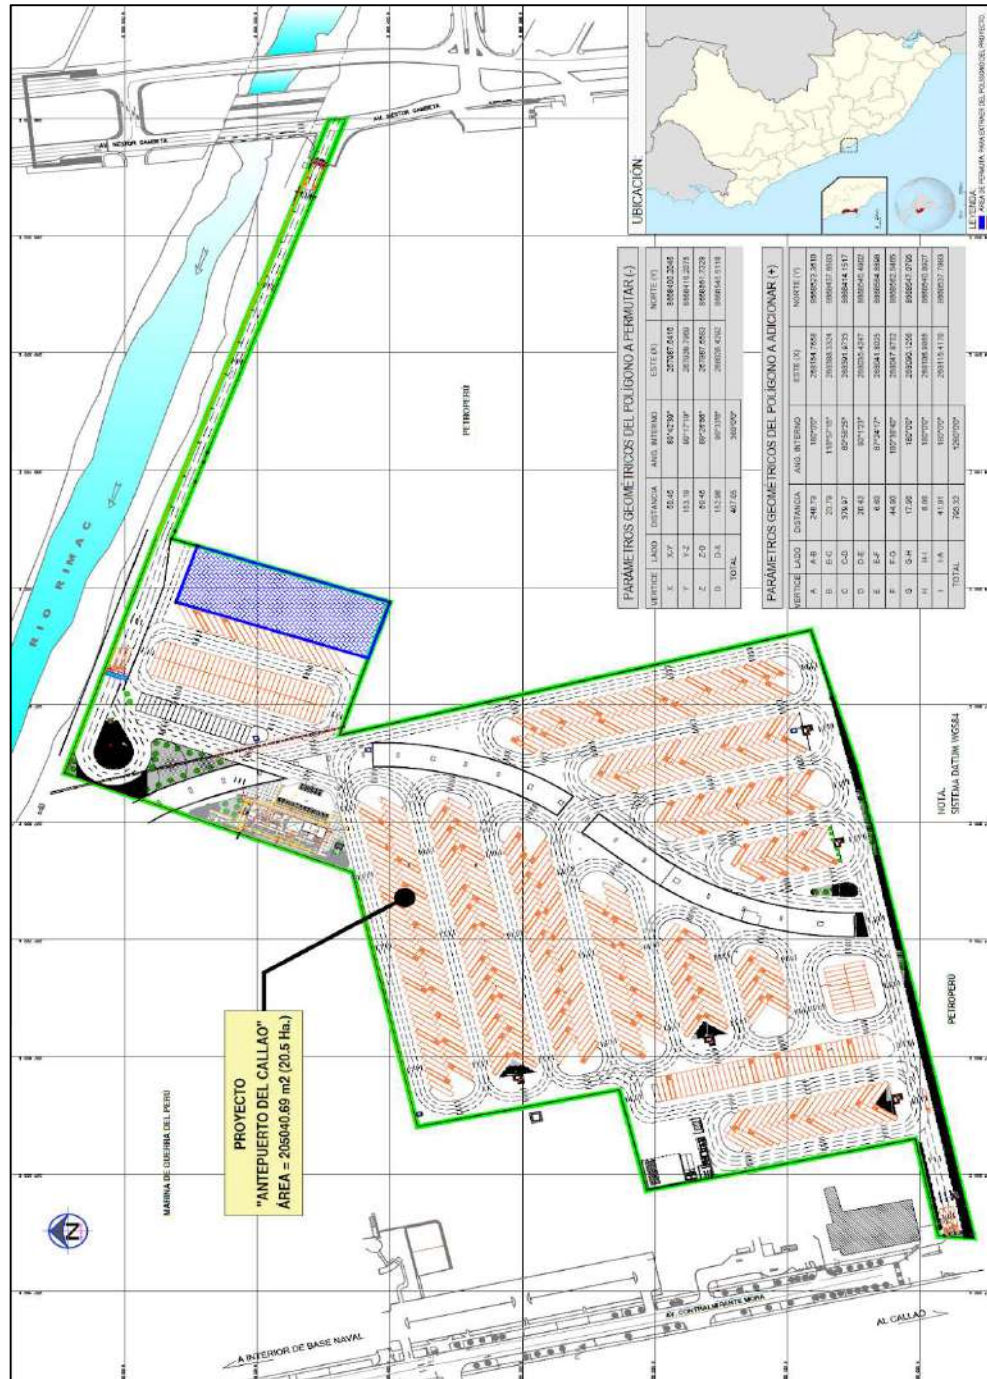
Plano de planta del Proyecto. Fuente: DGISTR.
